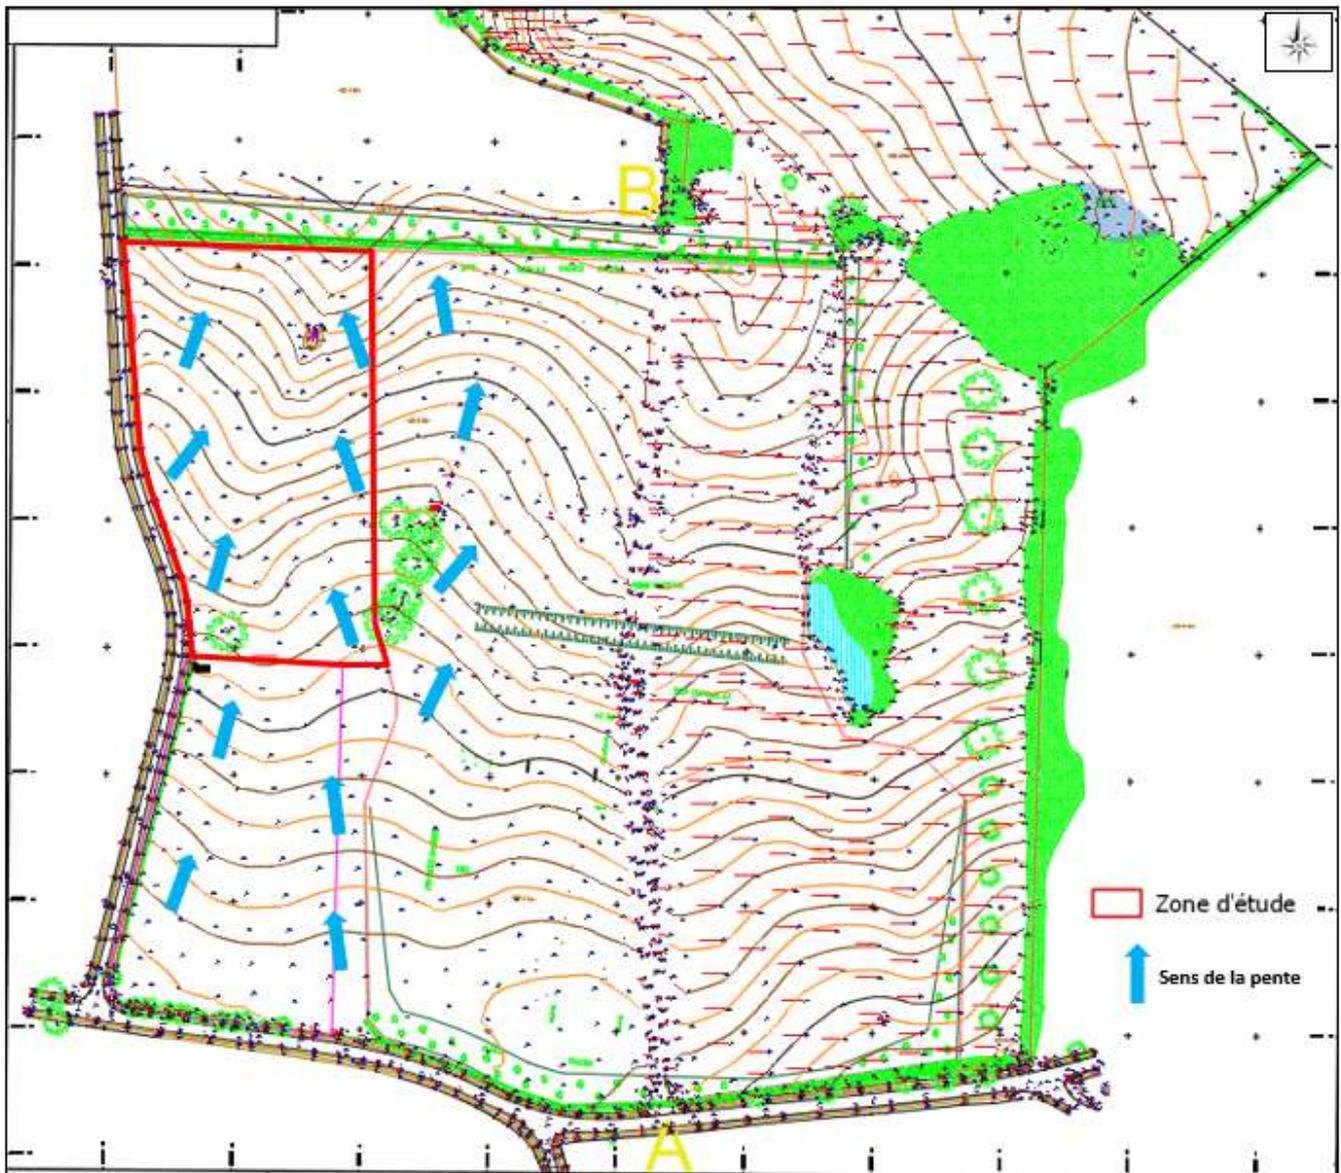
Plan topographique de la zone d'étude (Source : RTE)
